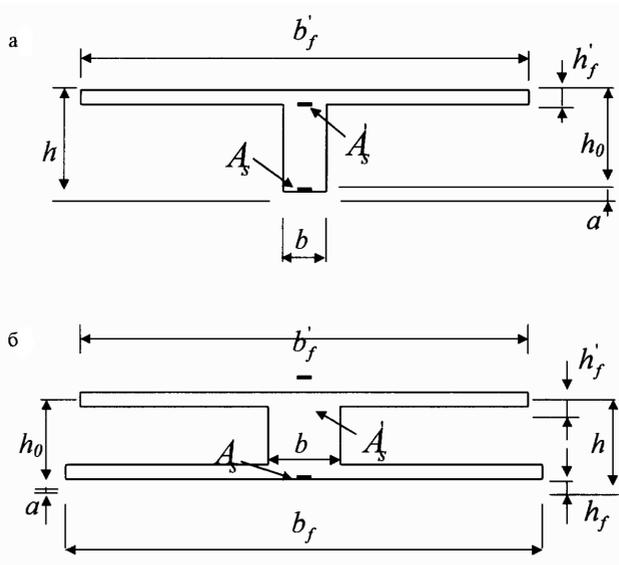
Расчетные поперечные сечения ребристых (а) и пустотных (б) панелей
